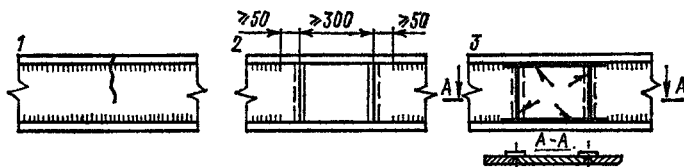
Устранение трещин в сварных стержнях двустенчатого сечения 1 — положение трещины; 2 — стенка вырезана, пояс заварен, установлены подкладки по вертикальным кромкам стенки; 3 — установлена вставка стенки, заварены вертикальные, а затем горизонтальные швы
